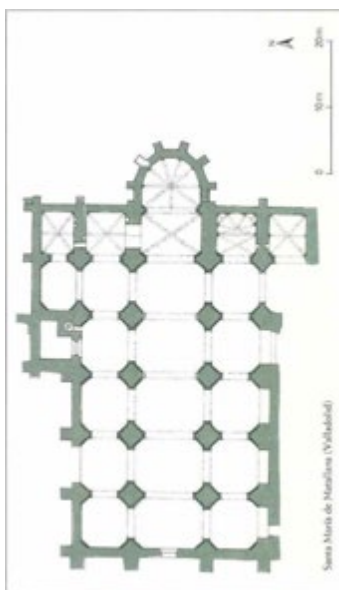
Matallana, Santa María, Grundriss Kirche, 1998.
